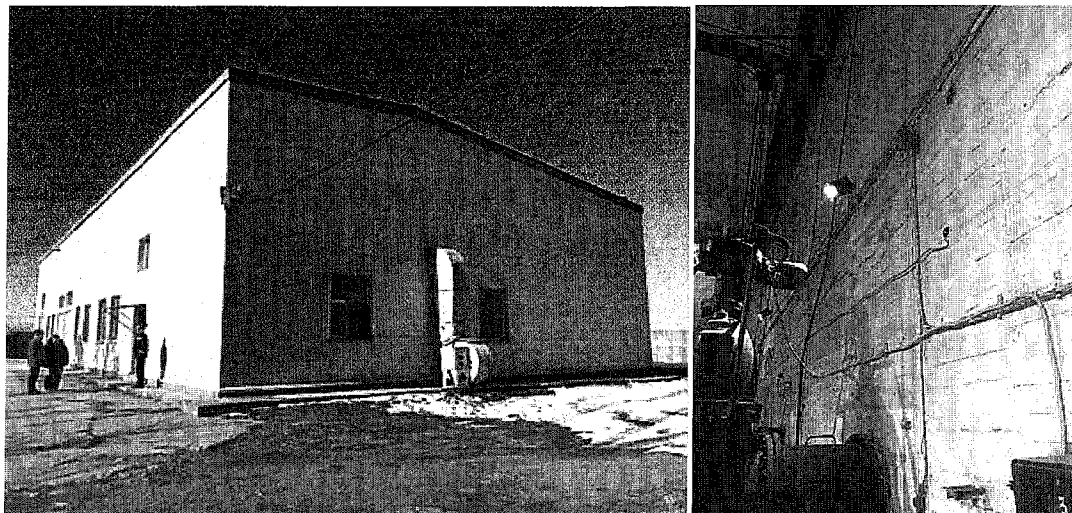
, 2. Здание ПВЗ-1 и стена заглубленного помещения
